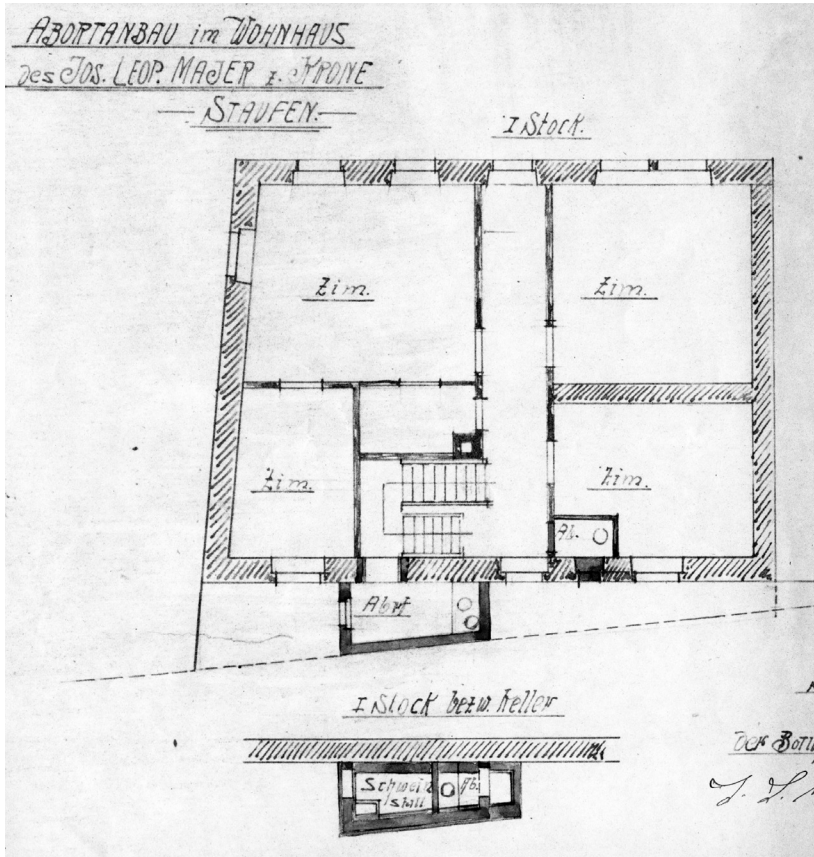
(links): Kirchstraße 11, Grundriss Erdgeschoss von 1919.
